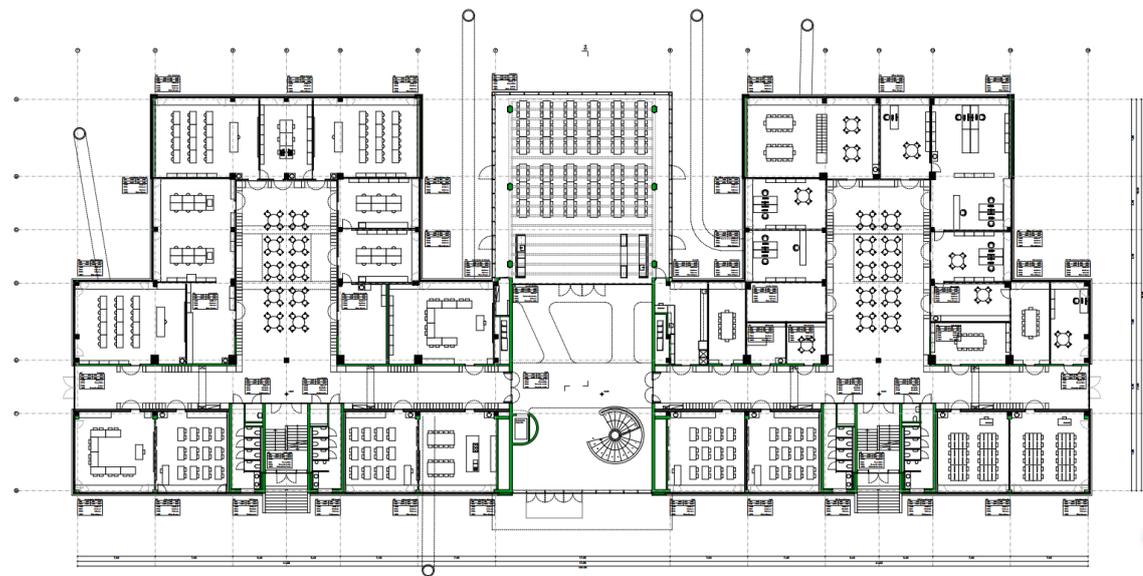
Pianta piano terra – Durisch + Noll Architetti sagl
